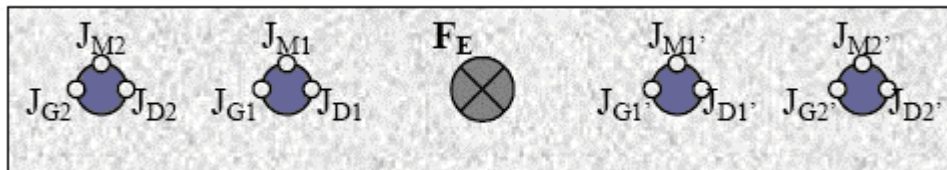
Schéma d'implantation des boulons instrumentés sur la bride.
